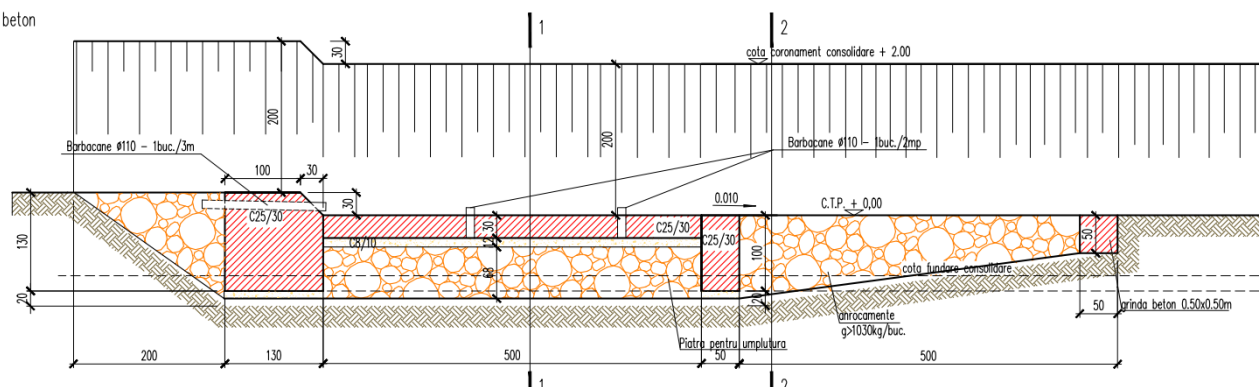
Secțiune caracteristică ST5 - Cădere de beton h=0,30 m
